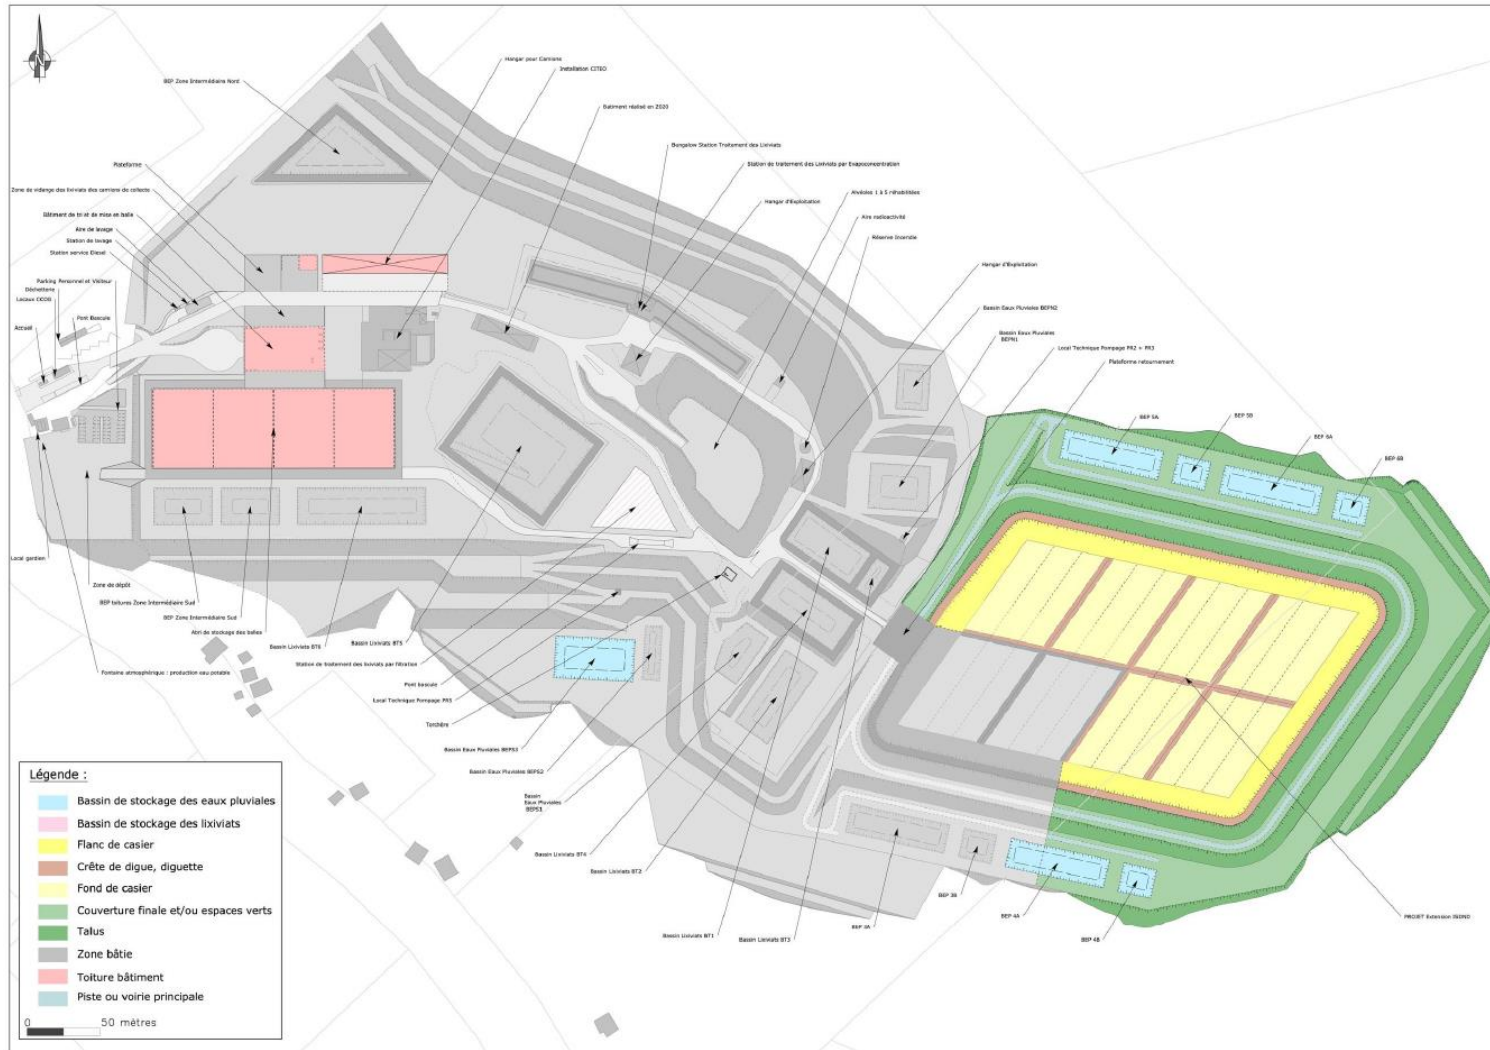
Plan général de l'installation projetée (Source : BETA Environnement)
